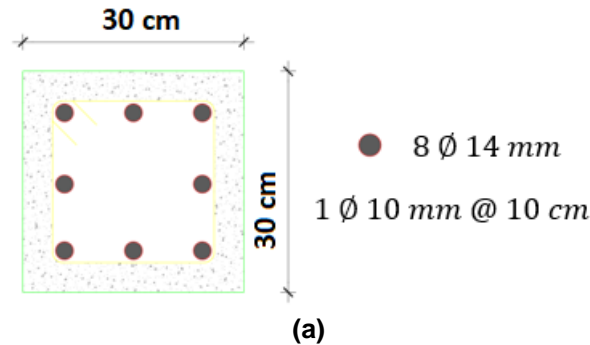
a) Columna de 30/30 cm, con 8 $\emptyset 14$ mm y armadura transversal de 1 $\emptyset 10$ mm espaciado cada 10 cm. Longitud de la columna de hormigón armado 3.50 m.
